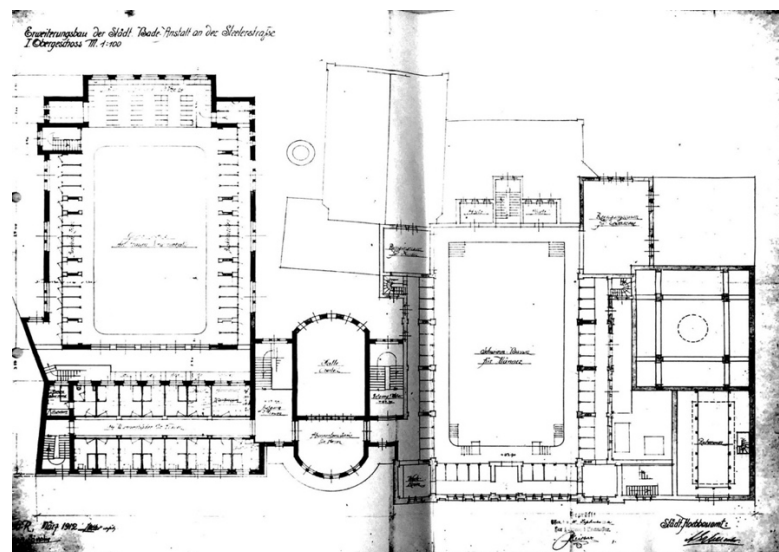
Albert Erbe, Erweiterung Städtische Badeanstalt Essen, Grundriss 1. Obergeschoss, März 1912 (HdEG Bestand 1044, Nr. 16)
